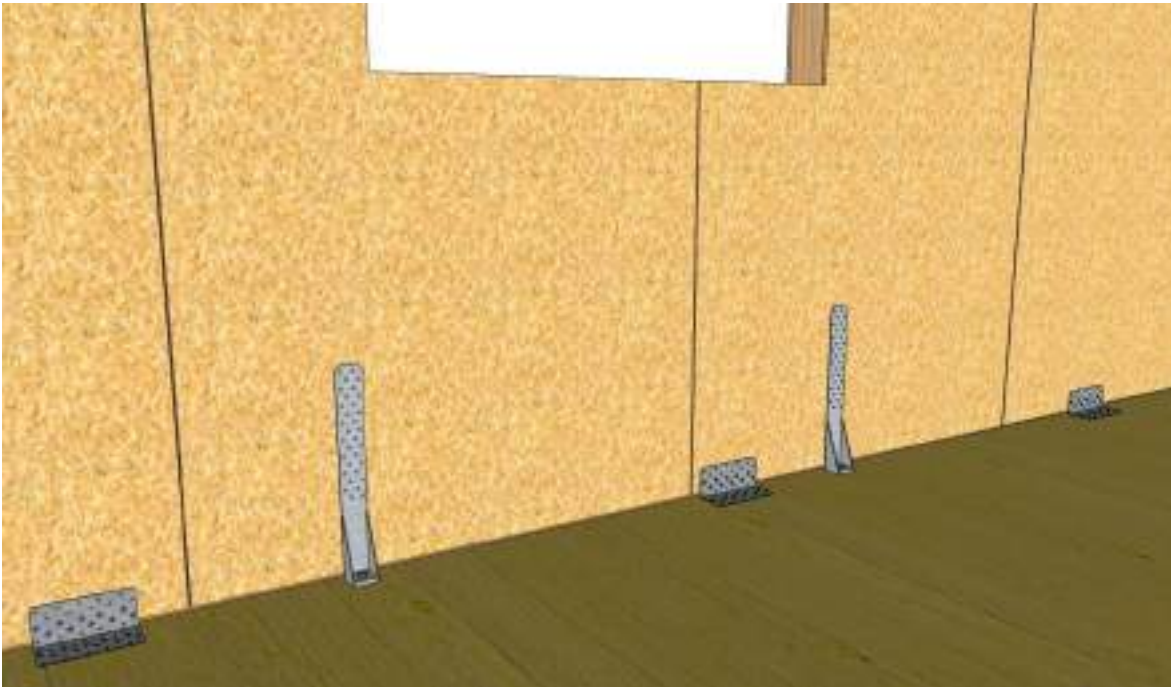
Mise en œuvre des équerres anti-soulèvement en pied de panneaux et en sous face de plancher
